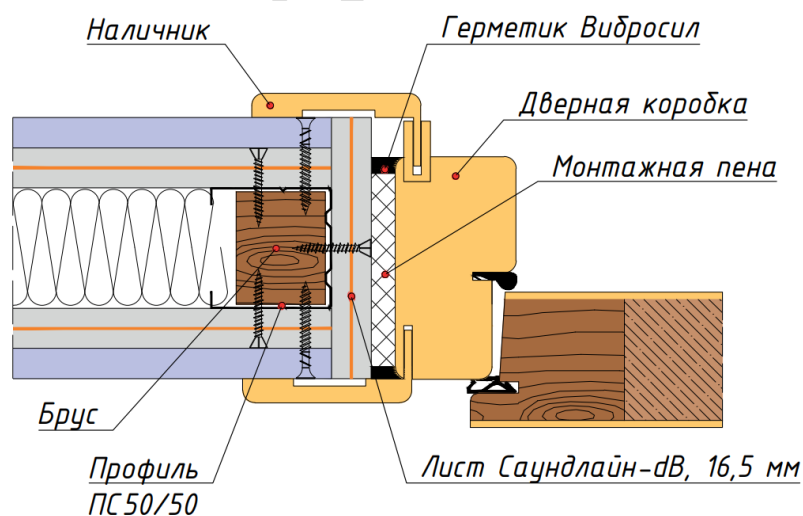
Оформление дверного проема в конструкции звукоизоляционной каркасной перегородки на одинарном каркасе.
